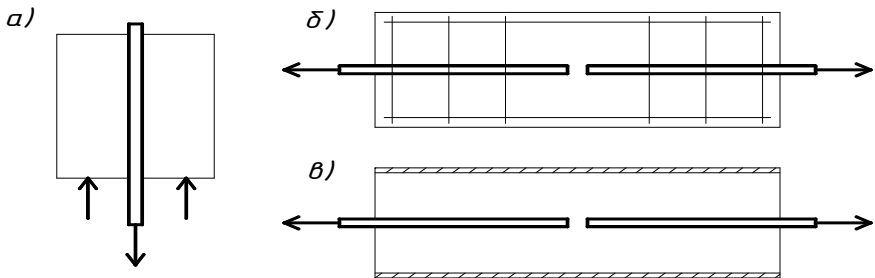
Схеми бетонної оболонки в моделях зчеплення арматури з бетоном: *а*) – неармованої; *б*) – армованої; *в*) – обрамленої металом
